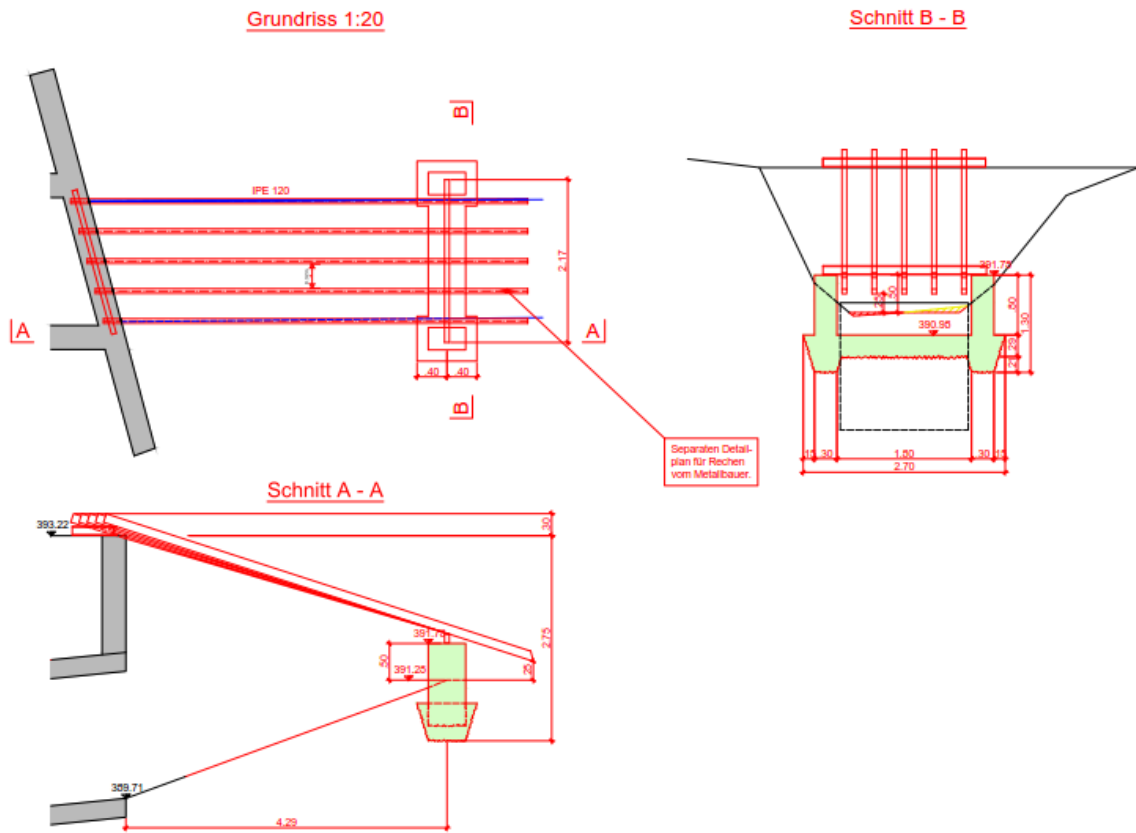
Grundriss/ Schnitte Grobrechen Durchlass Eg 06
